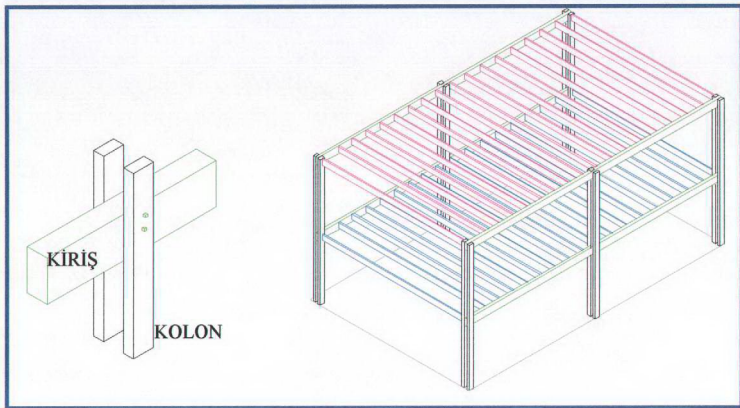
Sürekli Kiriş Sistemi ve Kolon Bağlantı Detayı
